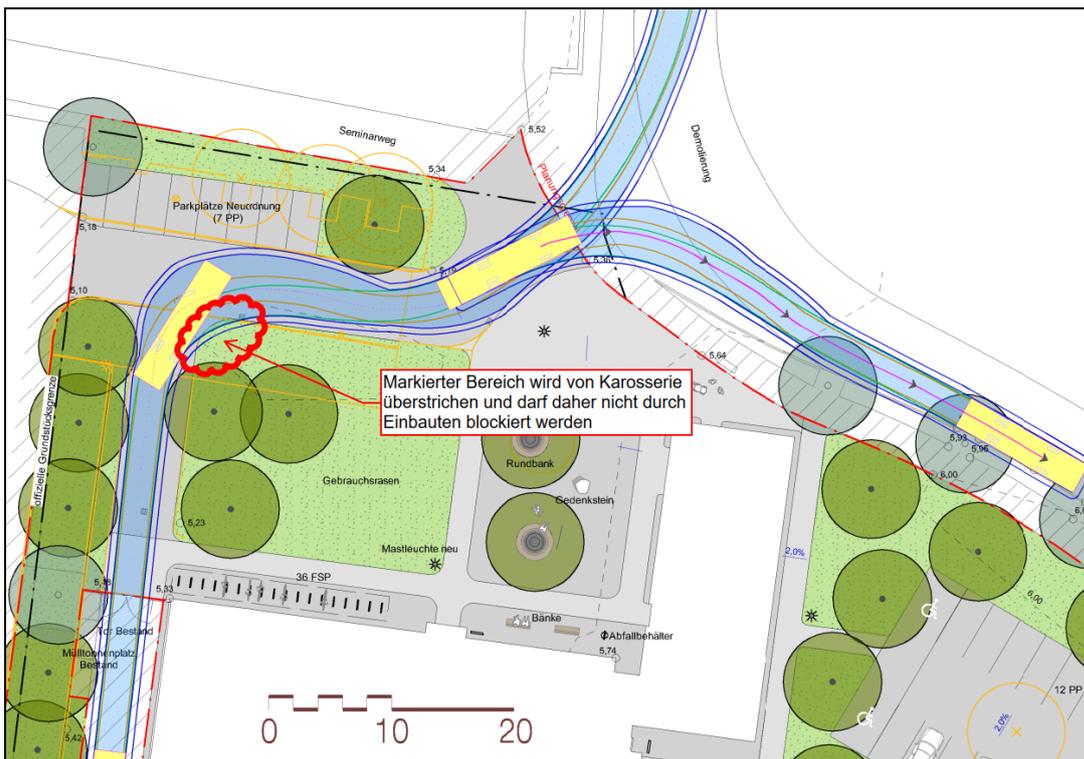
Ausfahrt Feuerwehr – Parkierungsanlage West
